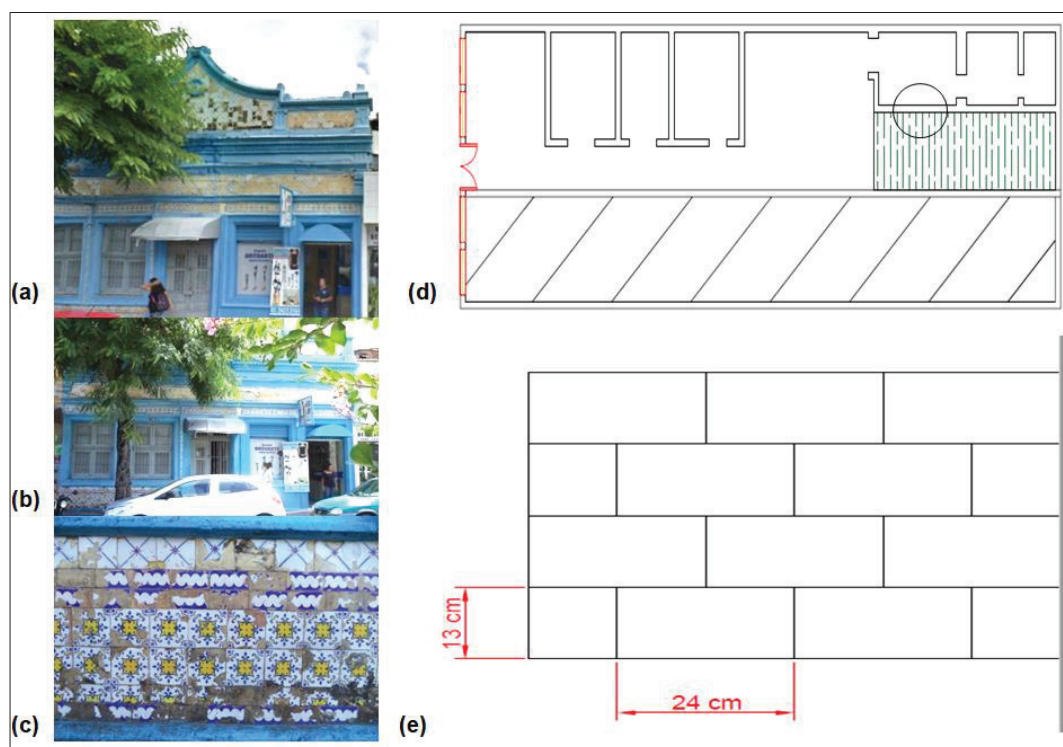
(a) e (b) Unidade de moradia 05 - Rua de São Gonçalo, N°34; (c) Azulejos policomáticos da fachada; (d) Planta Baixa, área hachurada em verde corresponde ao quintal e a área hachurada em linhas paralelas na diagonal corresponde à outra metade da morada que se tornou outra unidade; (e) Vetorização da paginação construtiva da unidade. Fonte: Arquivo pessoal, 2019
